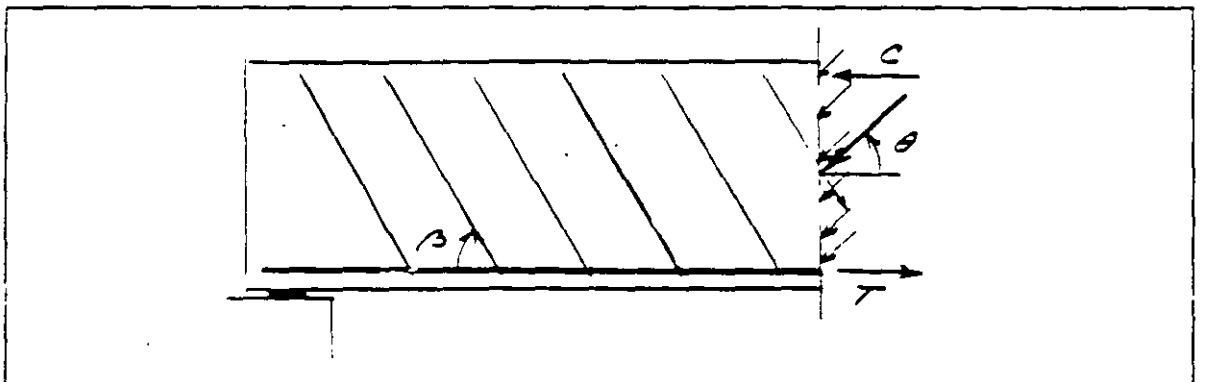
Definición de ángulo de los puntales y ángulo de los estribos
